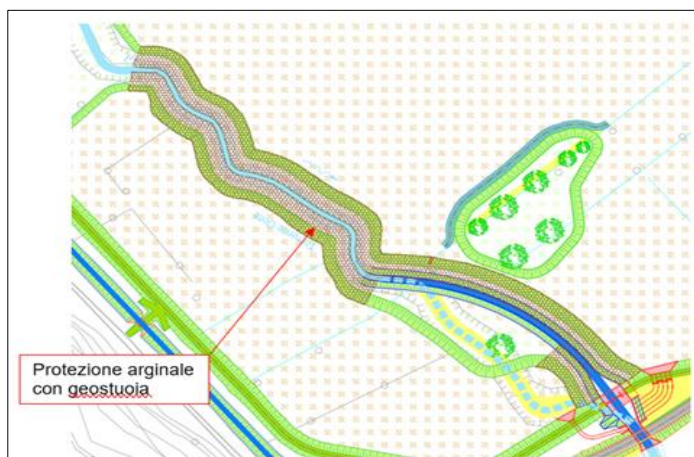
Estratto planimetrico dell'intervento di protezione degli argini sfioranti del T. Onte
